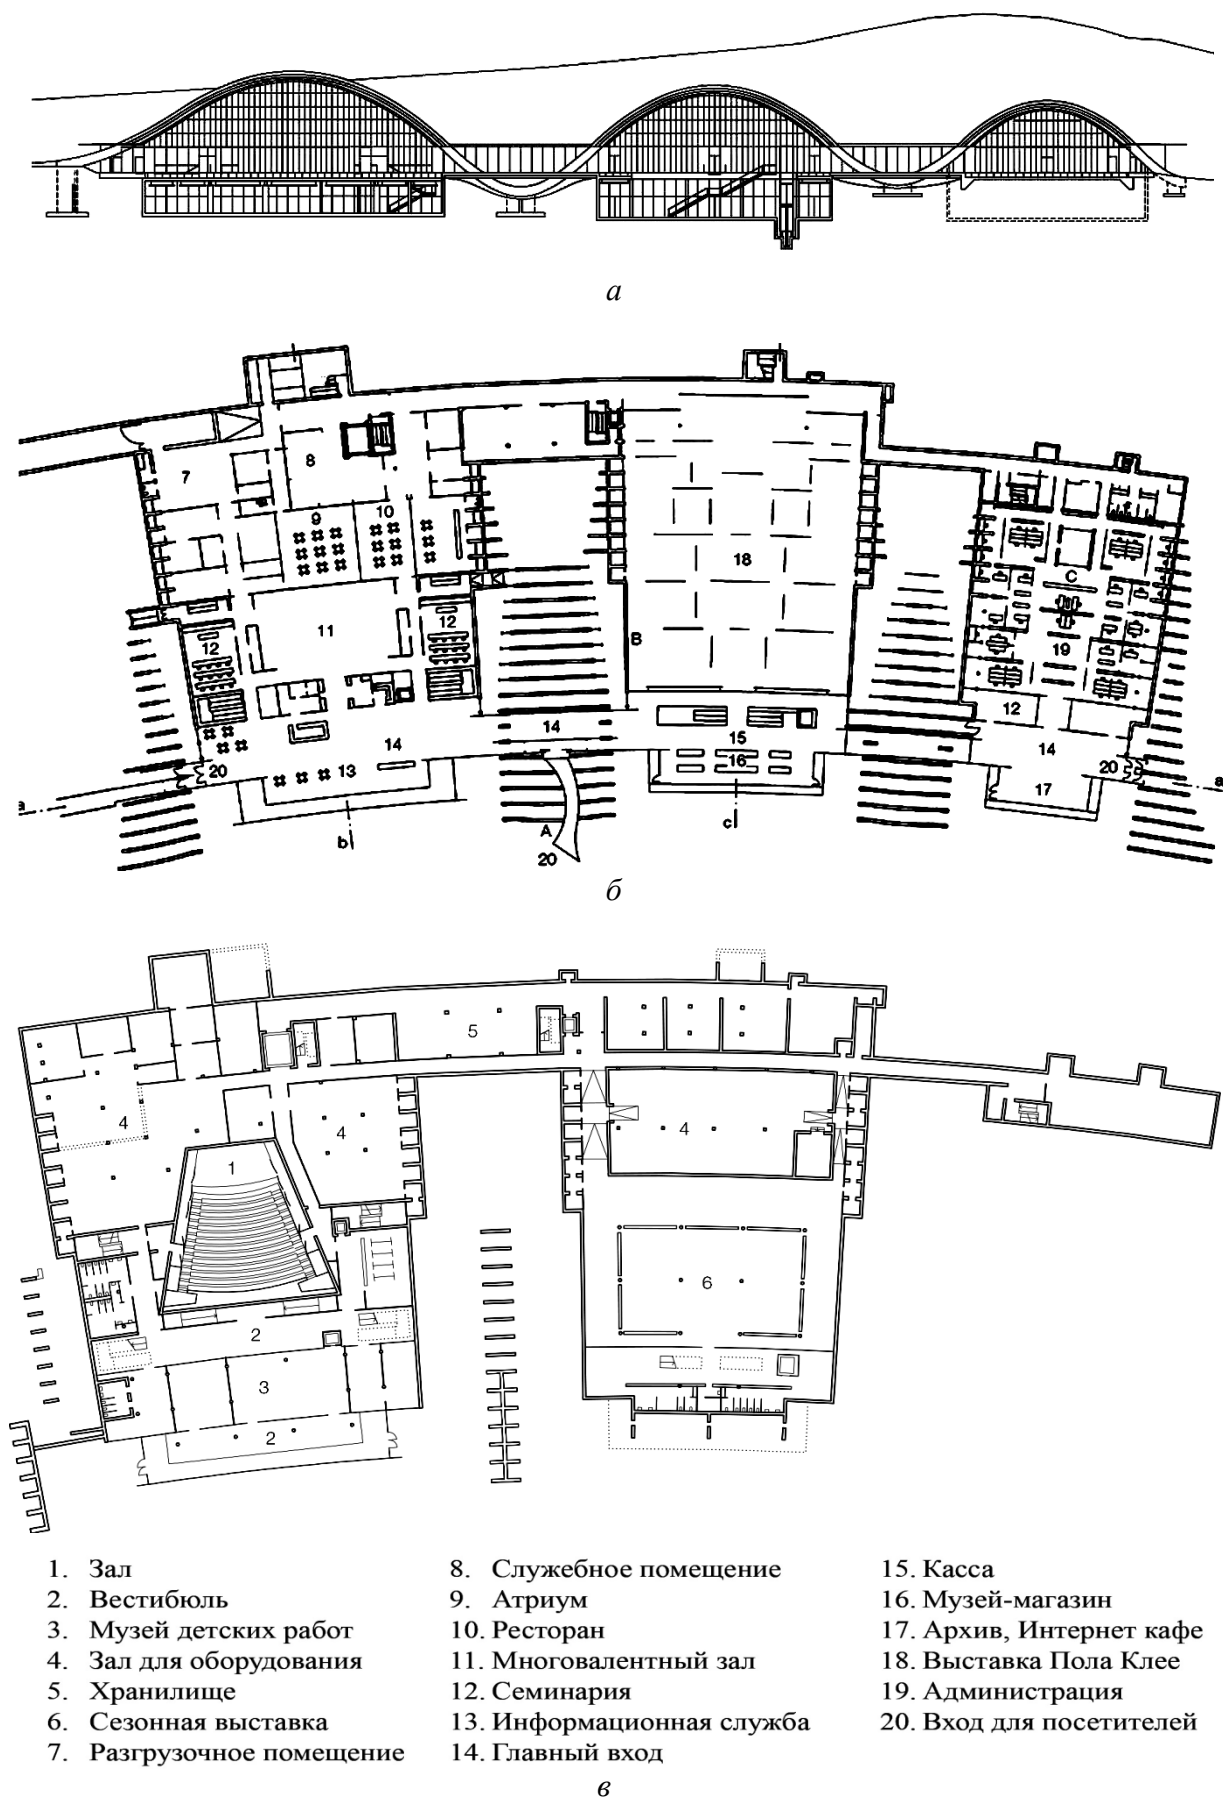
Основные объёмно-планировочные элементы: *a* – разрез по главному фасаду; *б* – план первого этажа; *в* – план цокольного этажа
